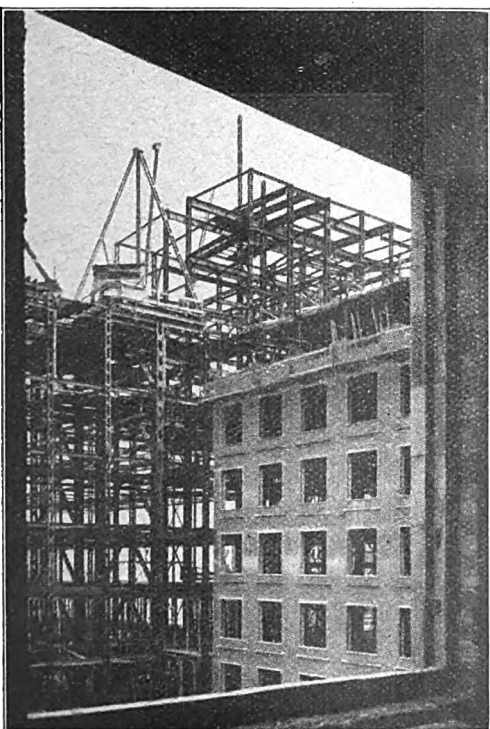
/10. Die Schnellbauerrüstung beim Neubau des Bernerwerkes in Berlin-Siemensstadt.
